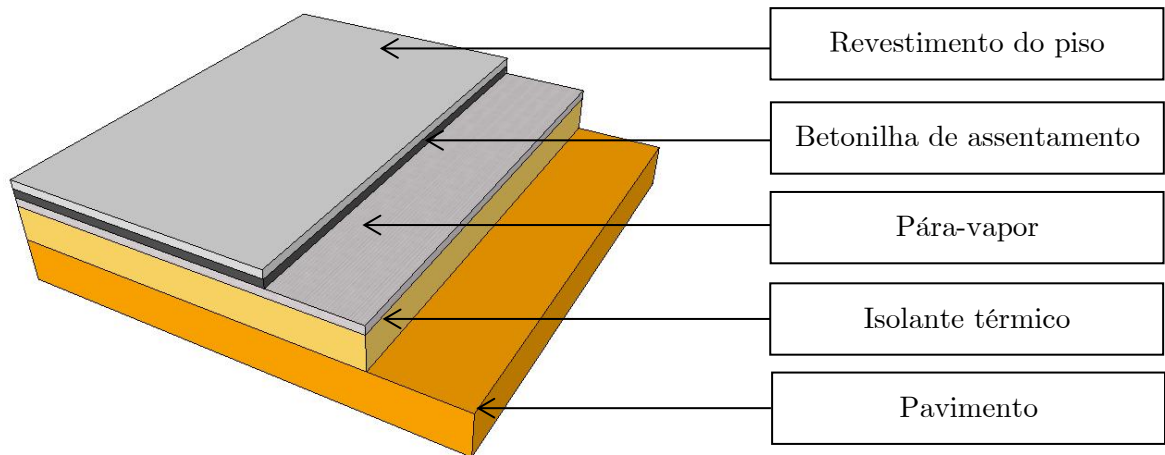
Sistema de isolamento térmico em pavimentos exteriores aplicado pela face superior da laje de pavimento
